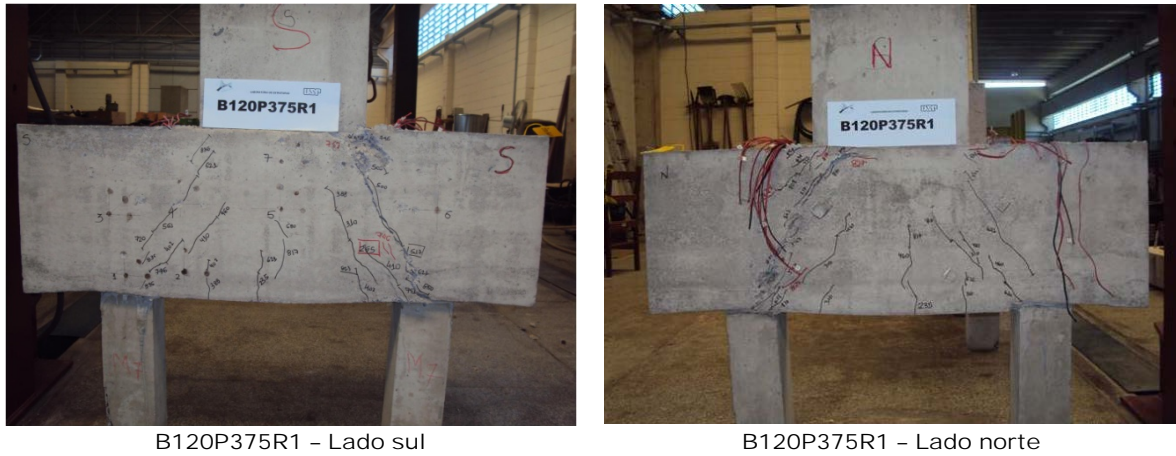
Configuração de fissuras modelo B120P375R1
